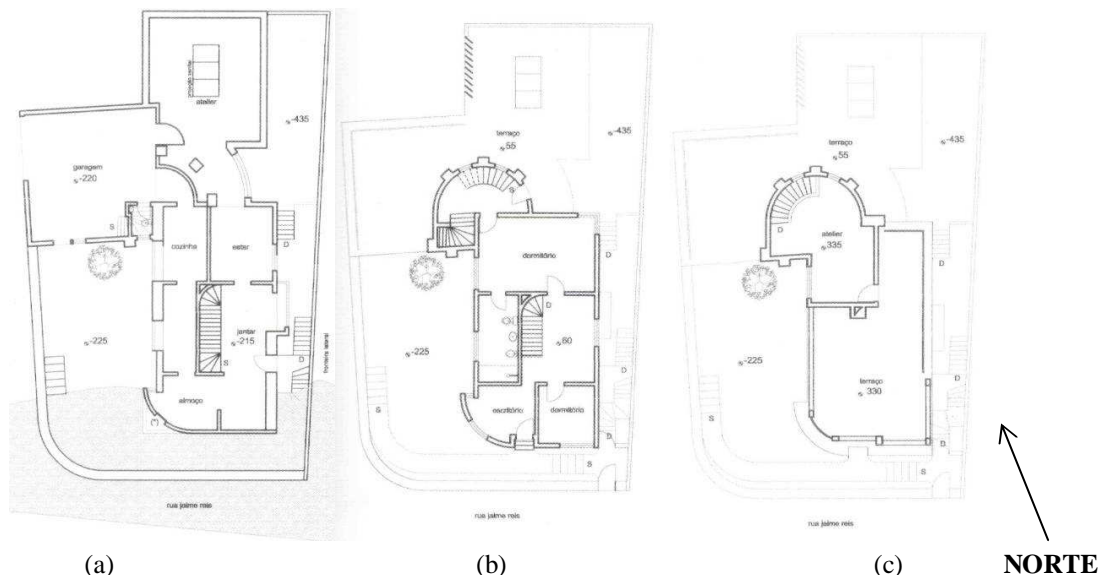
Plantas primeiro pavimento (a), segundo pavimento (b) e cobertura (c) (DUDEQUE, 2001)
